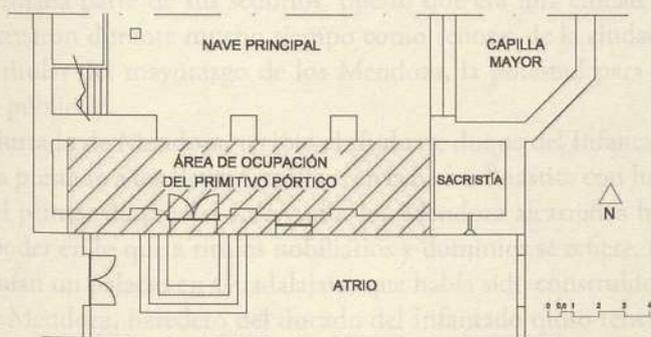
Planimetrías de la iglesia de Alcuneza y reconstrucción del pórtico.
